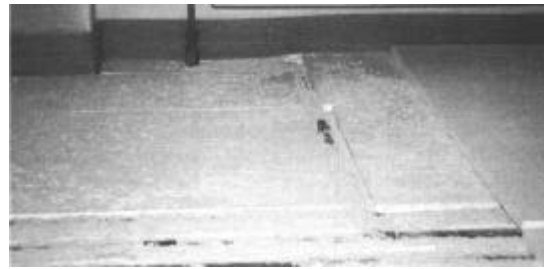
Die untere Lage der Dämmschicht gleicht aus, die obere Lage der Dämmschicht (Trittschalldämmplatten) muss vollflächig darüber verlegt werden
